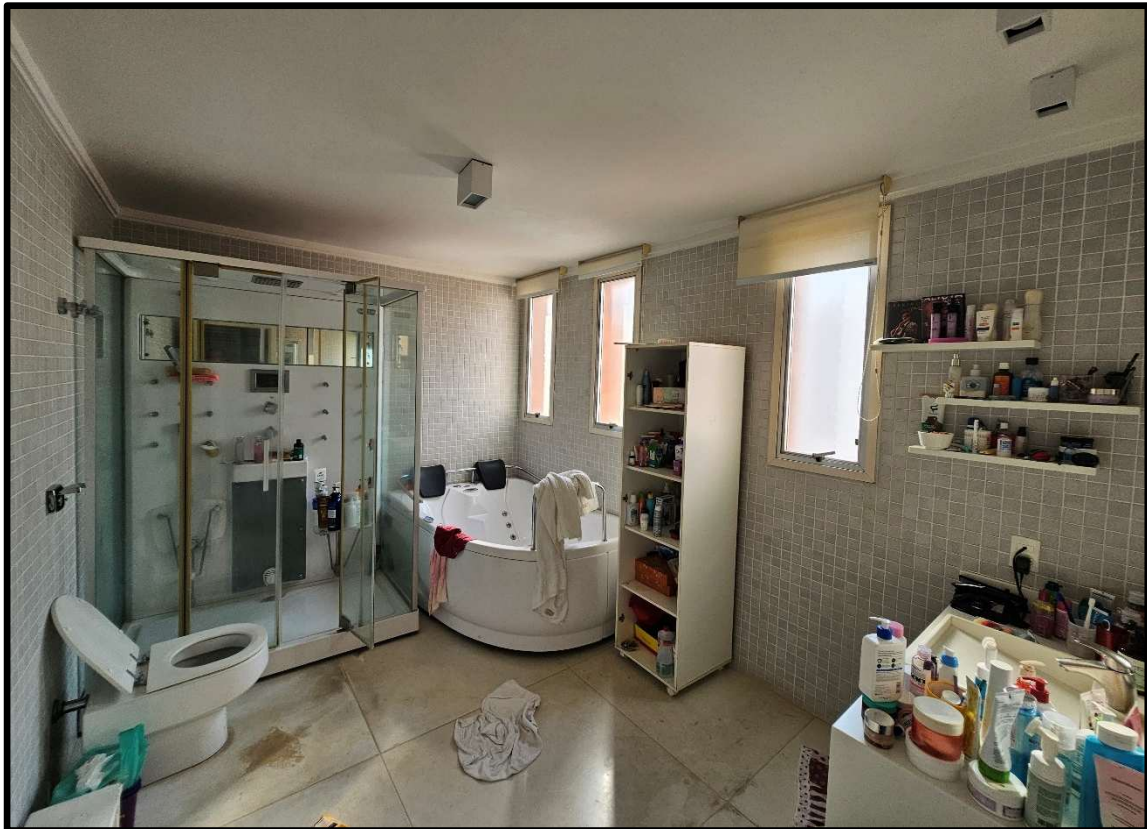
Banheiro - 1ª Suíte (1º Pavimento)
